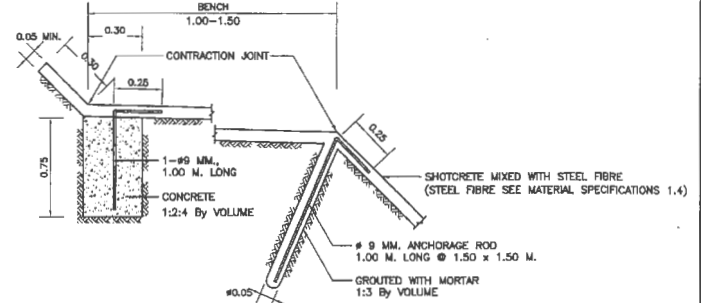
SHOTCRETE ON BACK SLOPE AND SIDE SLOPE PROTECTION
